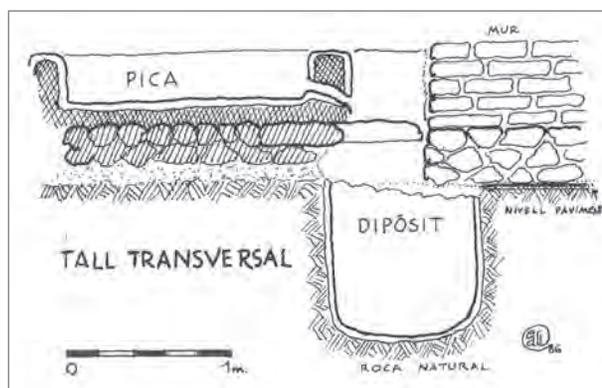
Sección transversal de la zona de las piletas según Llobregat.
